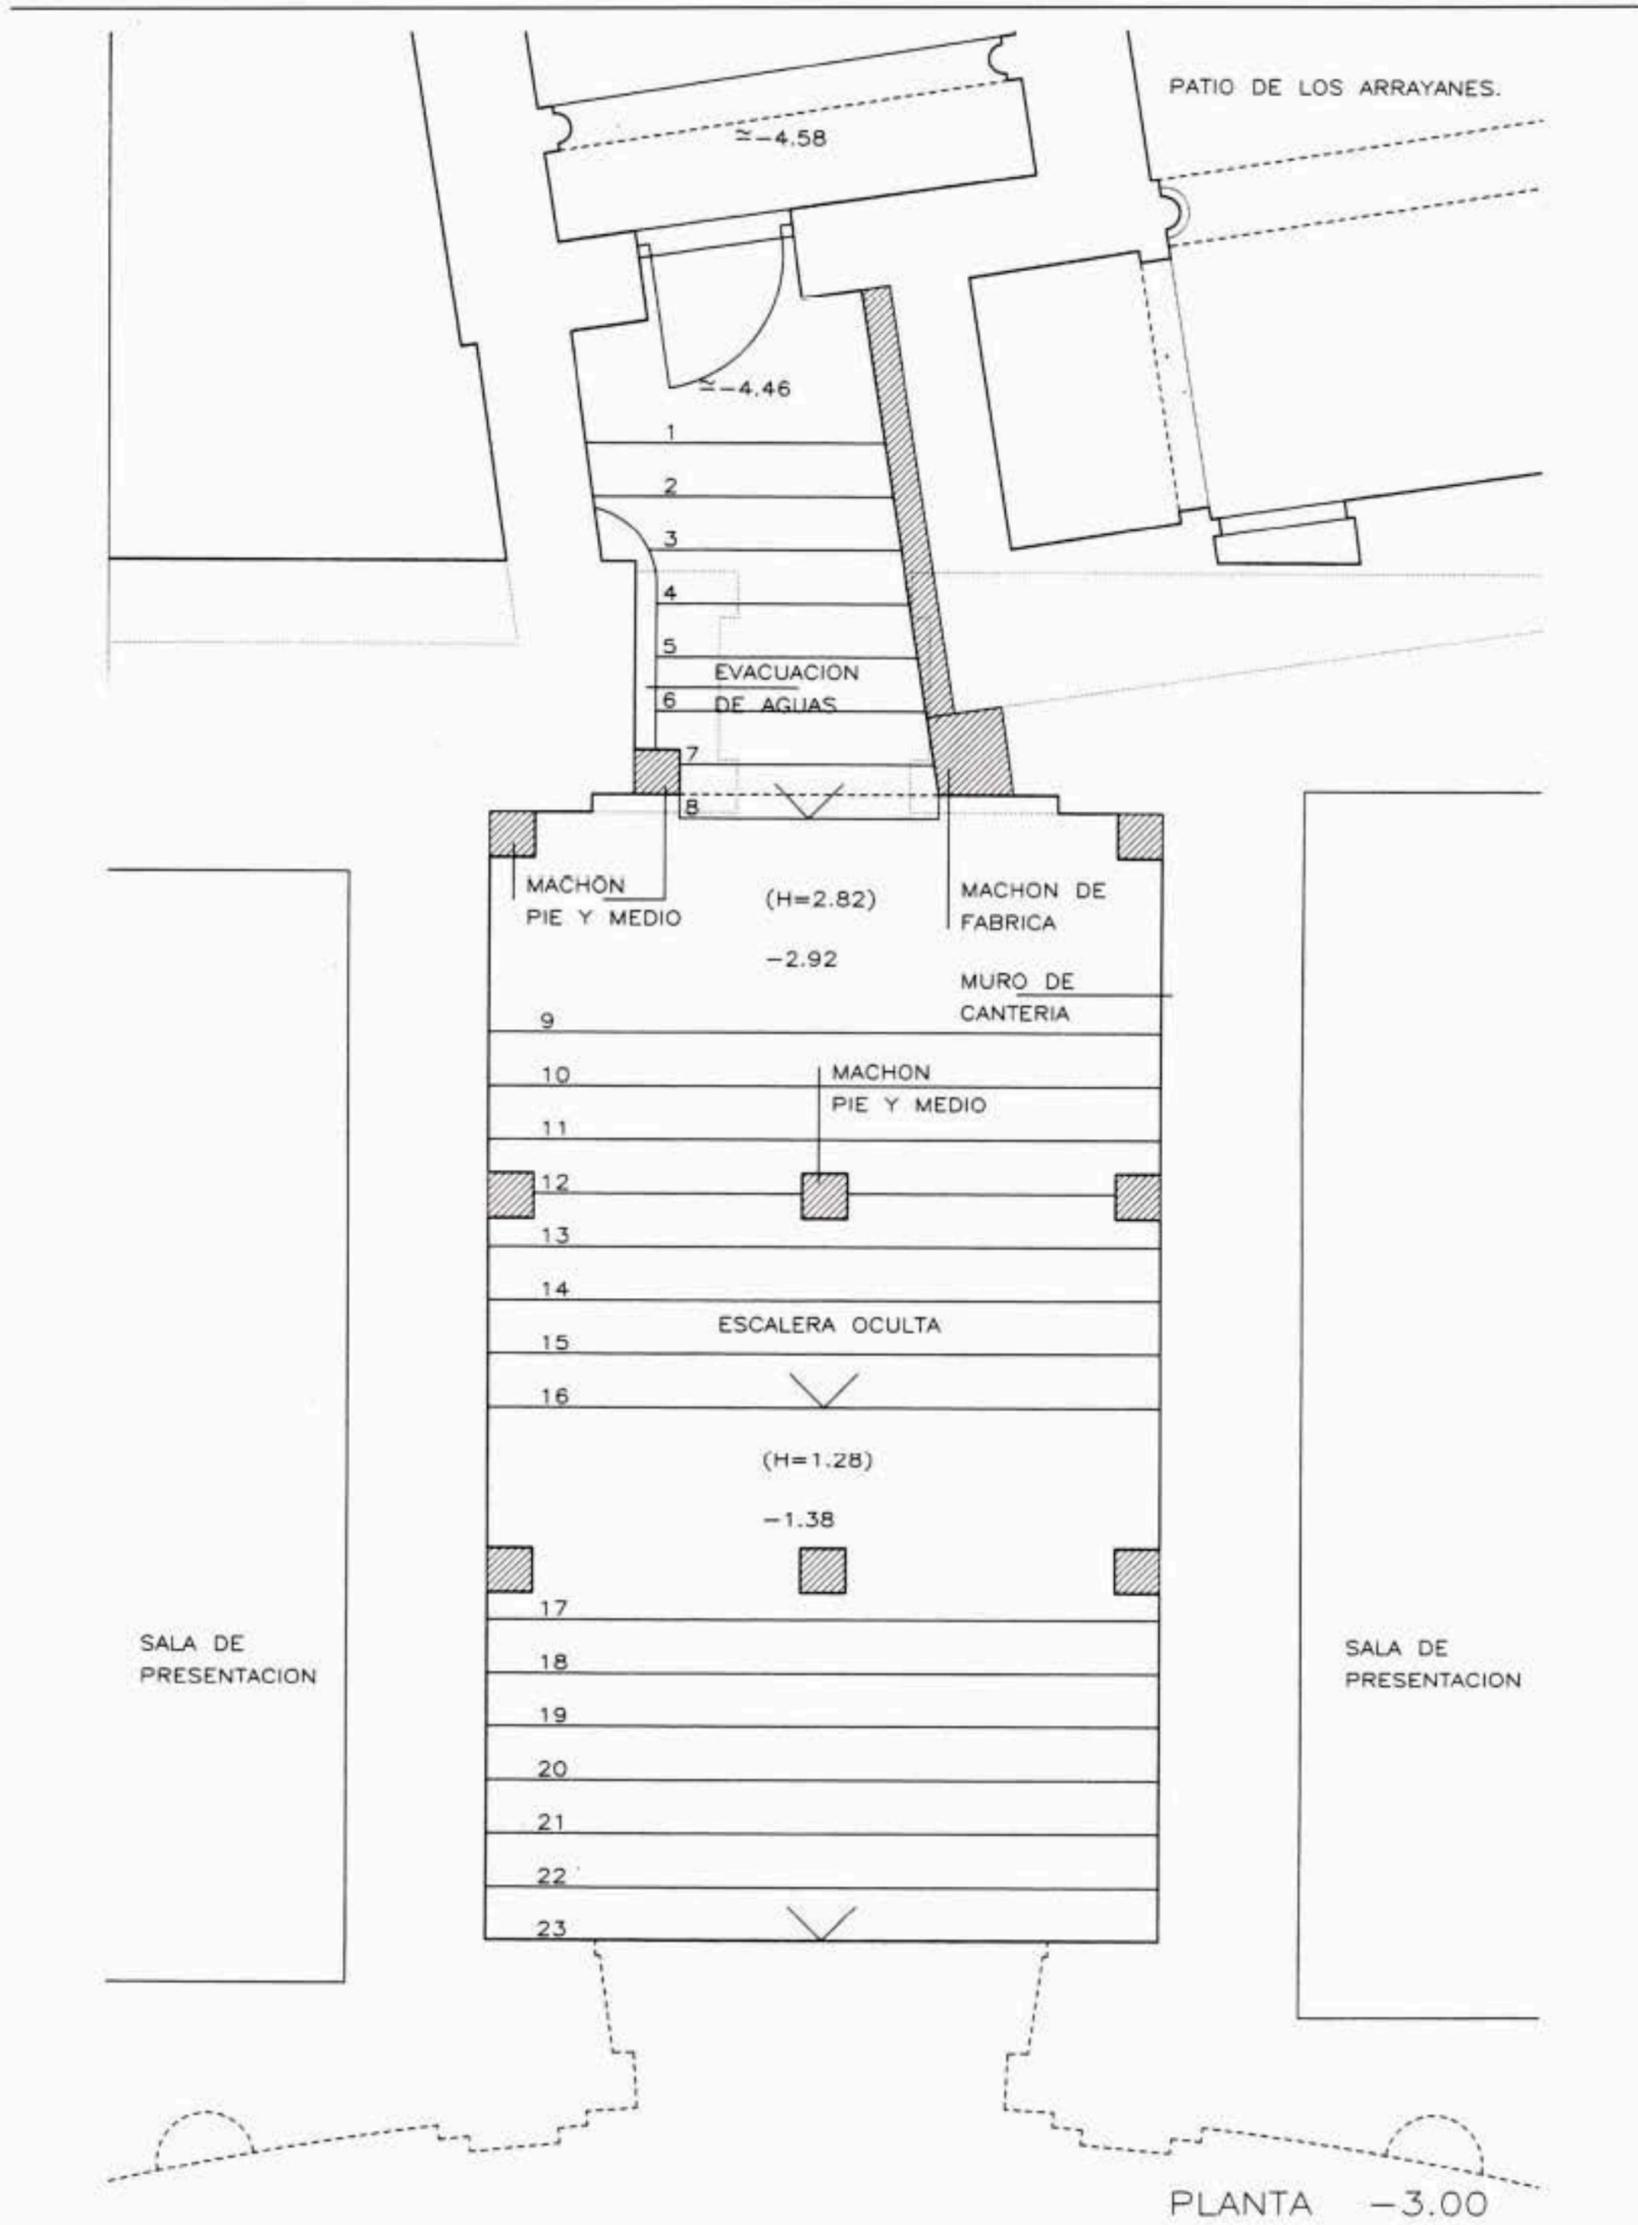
Estado Anterior. Planta cota -3,00 m.
